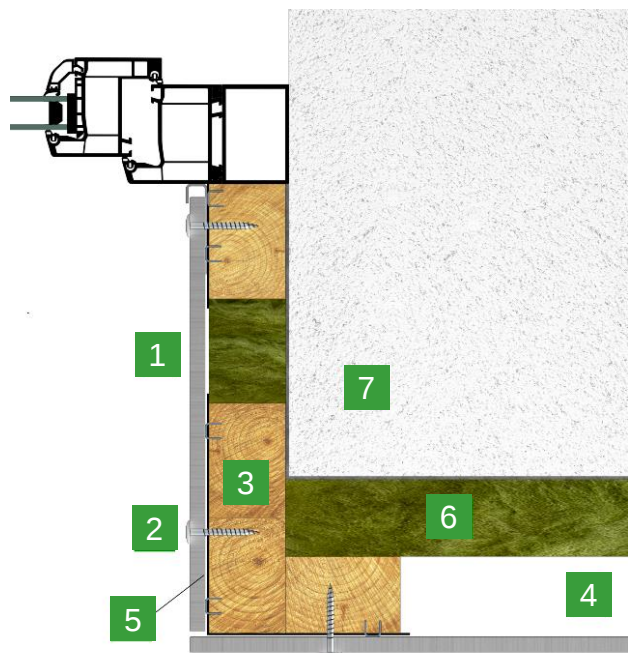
Sección horizontal. Telar de jamba con placa Hardie® Panel.
